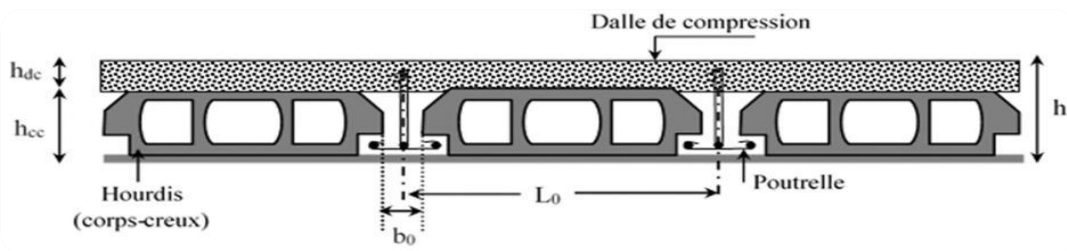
Coupe transversale d'un plancher à corps creux
